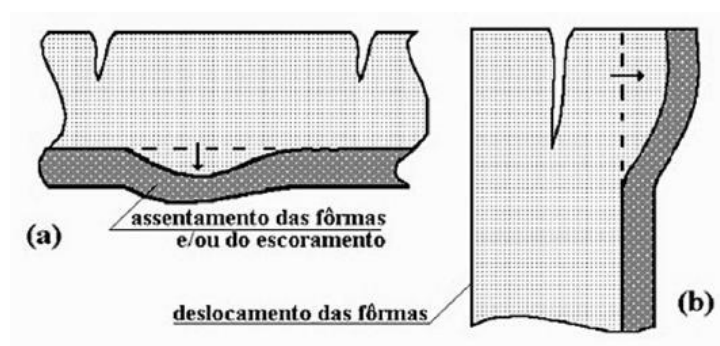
Exemplo de fissuração por movimentação de fôrmas e escoramentos (Souza & Ripper, 1998).
